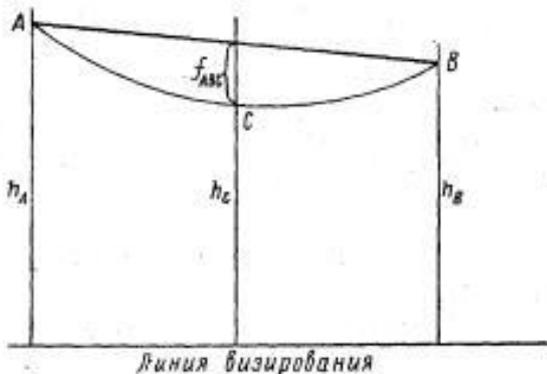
Вычисление прогибов балок перекрытий с учетом разности отсчетов по крайним точкам балки
